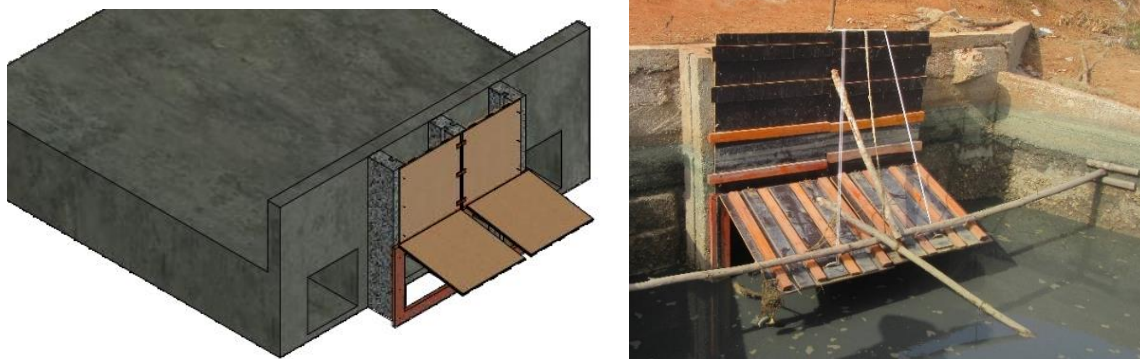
Gauche : Schéma de construction de vannes à clapet sur l'ouvrage de Séguéma. Droite : Photo de la construction finale.
